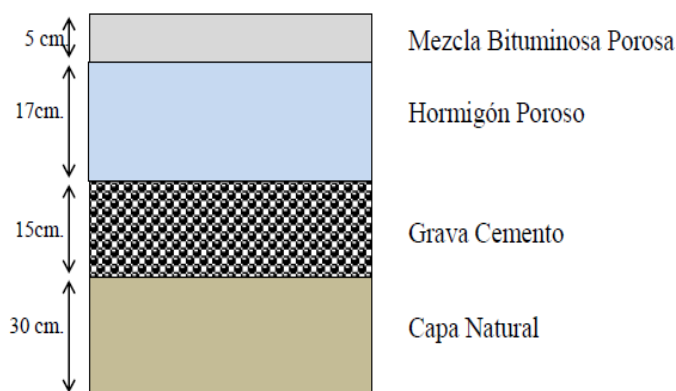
Fig. 2.50 Base para pavimento de concreto permeable
